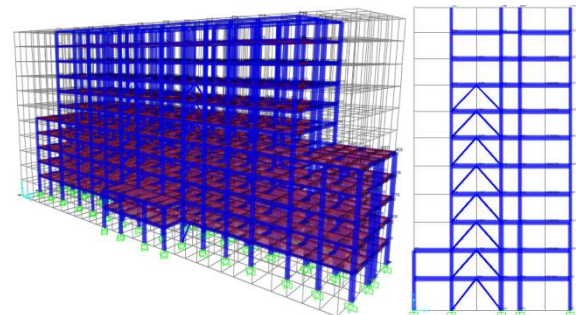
Struktur Alternatif dengan Single Brace (Tipe B)
